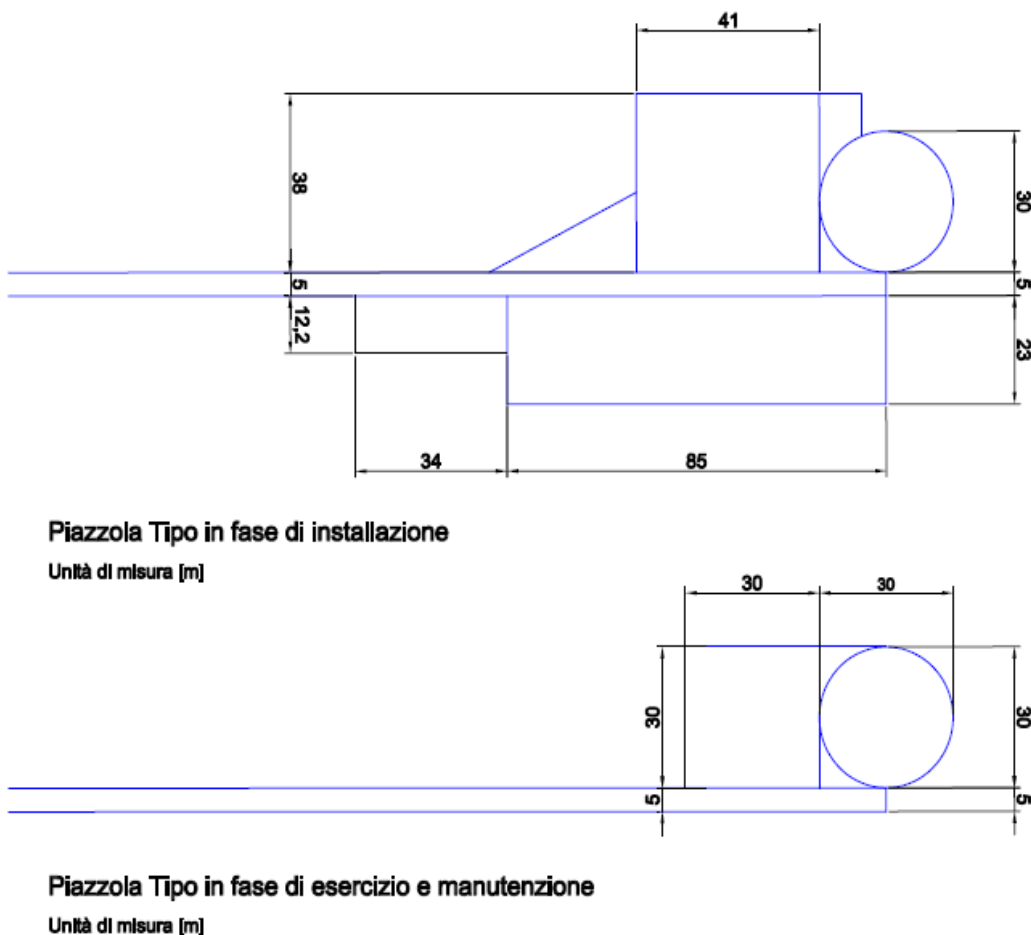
Planimetria piazzola tipo per la fase di installazione e fase di esercizio e manutenzione
